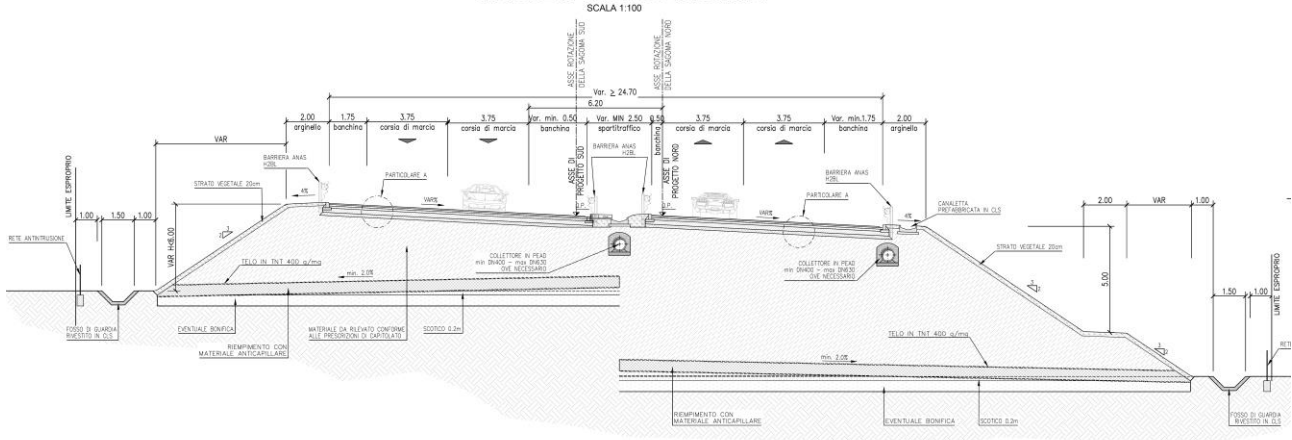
Sezione tipo in rilevato dell'asse principale
